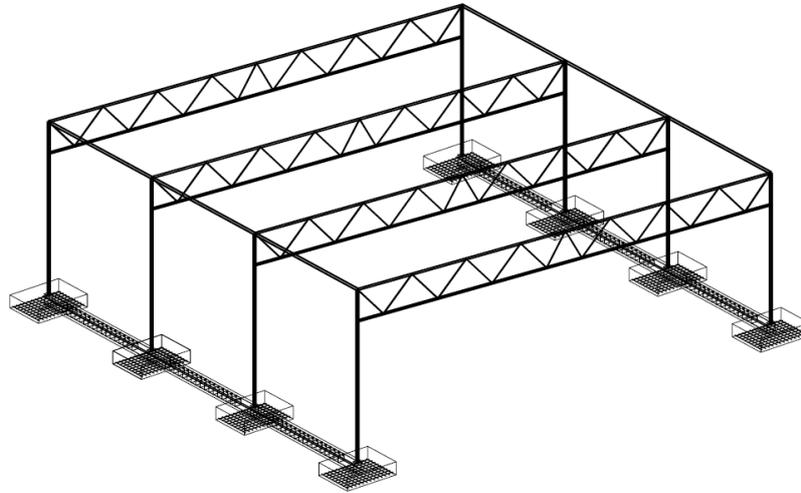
Detalle de la estructura existente en la parcela (planos a escala en el proyecto)
